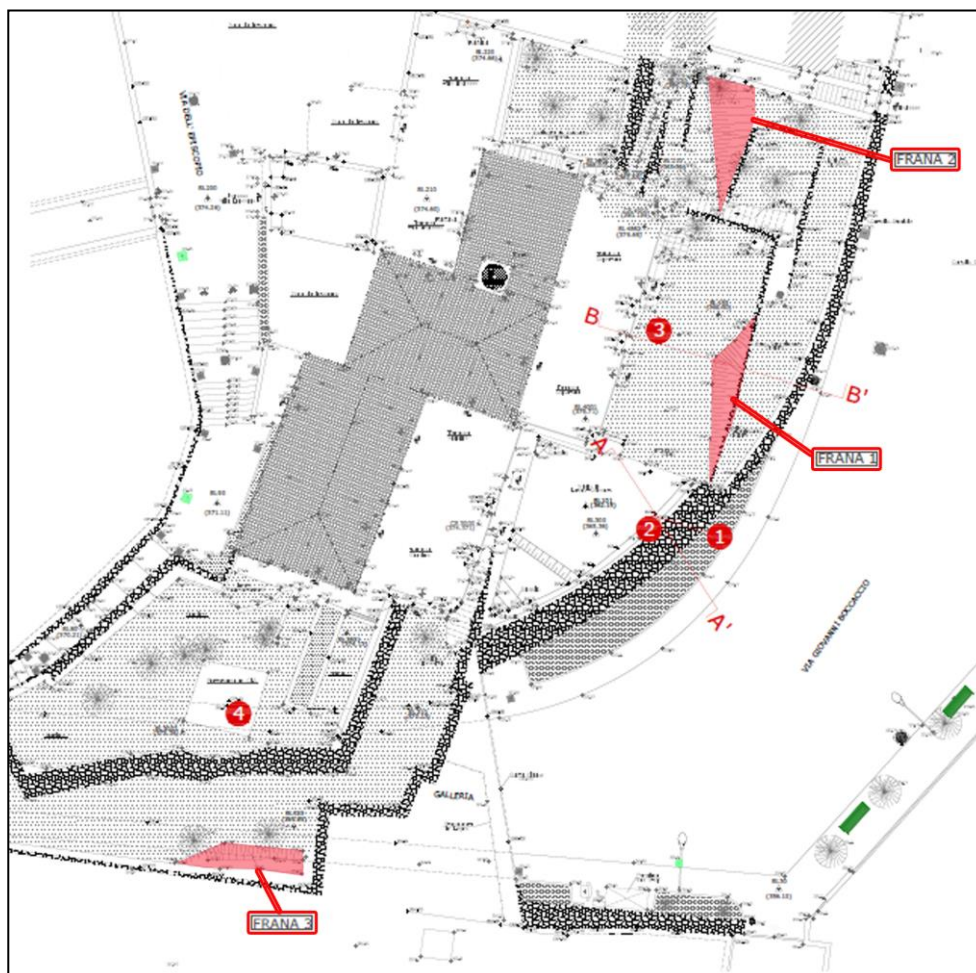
Planimetria topografica con individuazione delle zone in frana
